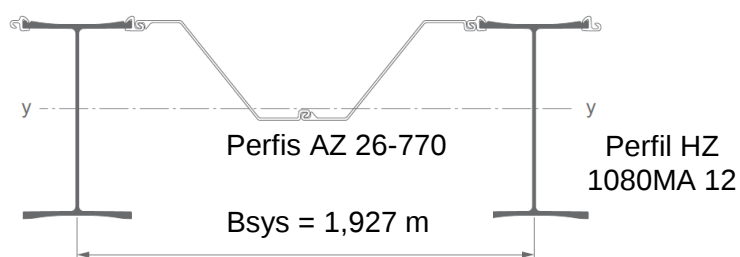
Elementos da Cortina de cais – sistema *CombiWall* (ArcelorMittal, 2011)
